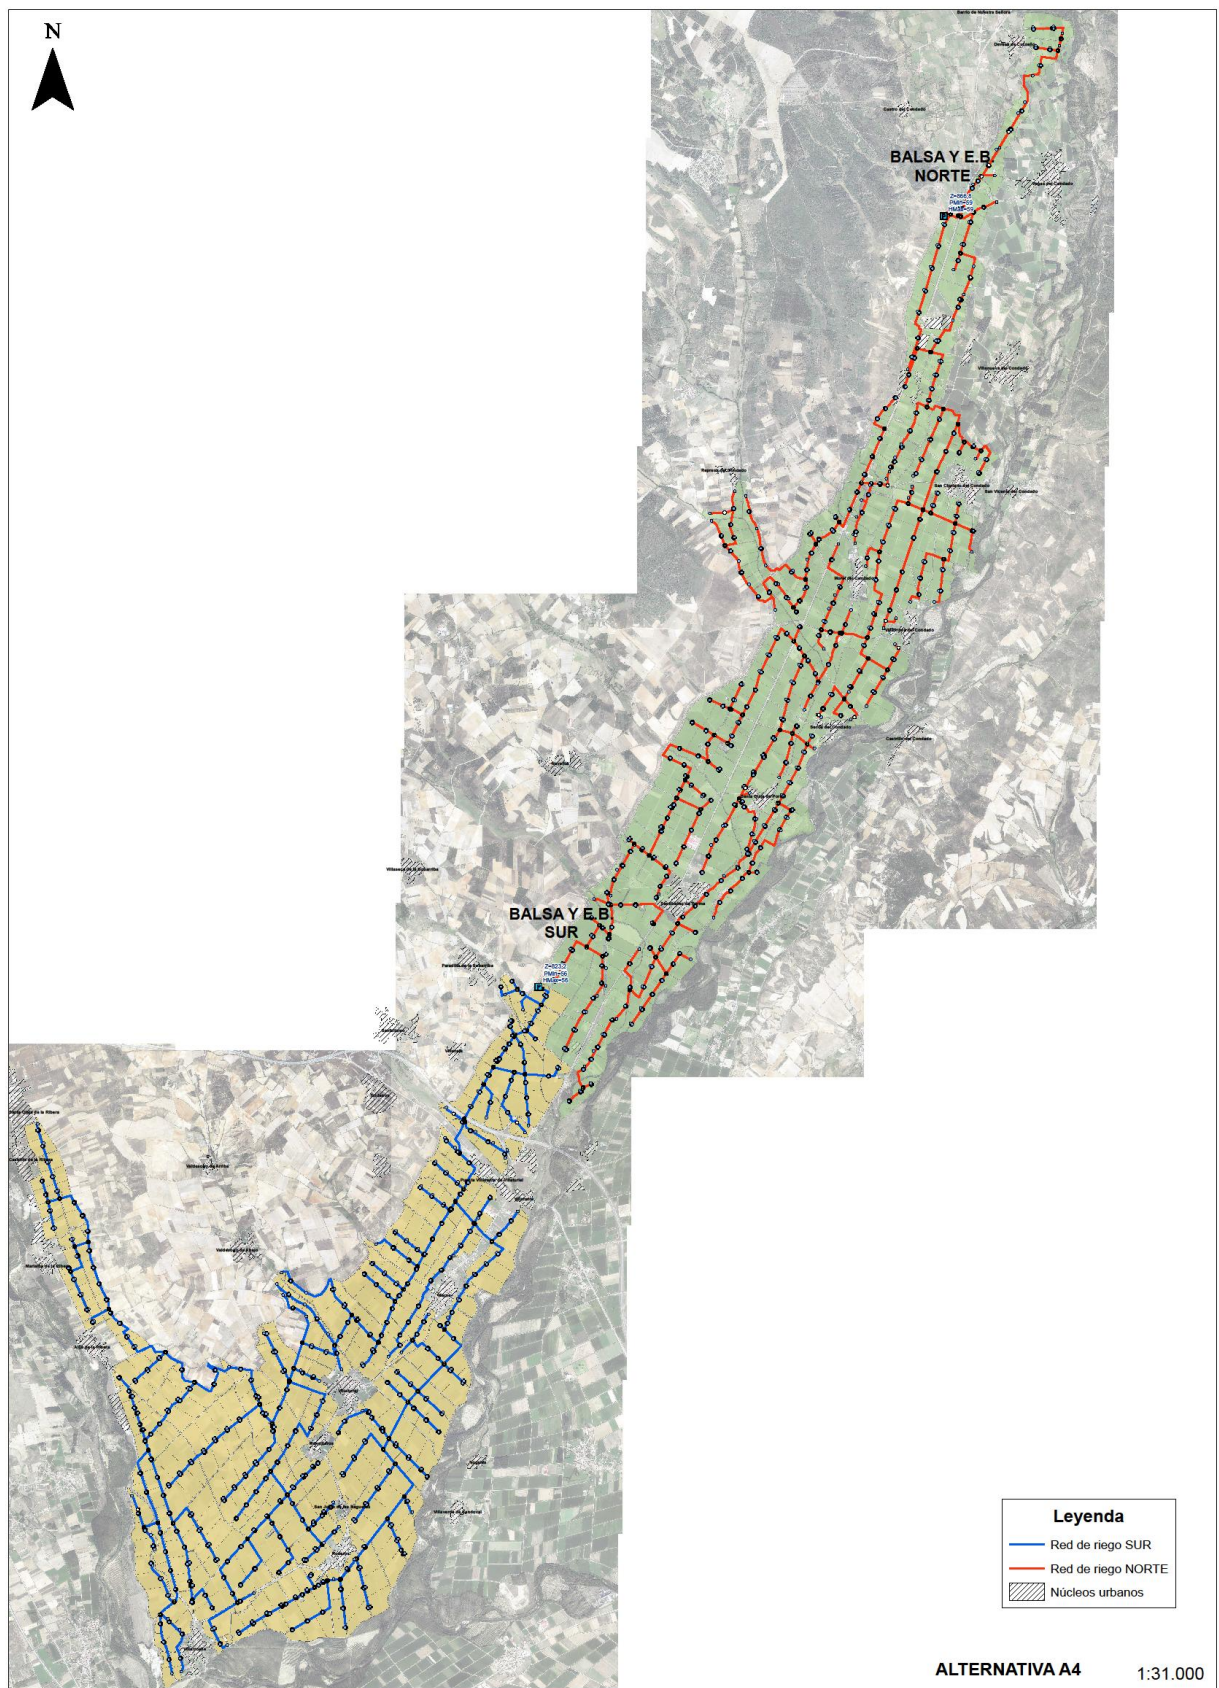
Ubicación de las infraestructuras en la Alternativa 4
